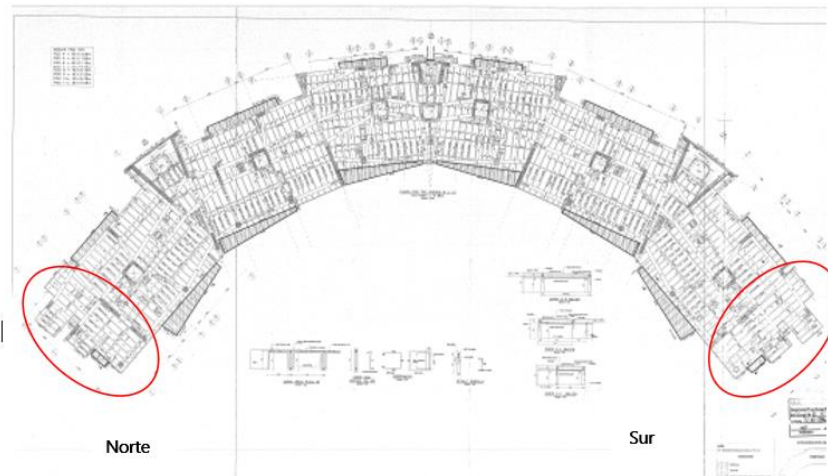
Planta Tipo, Sectores afectados Fachada Norte-izquierda y Sur-derecha
